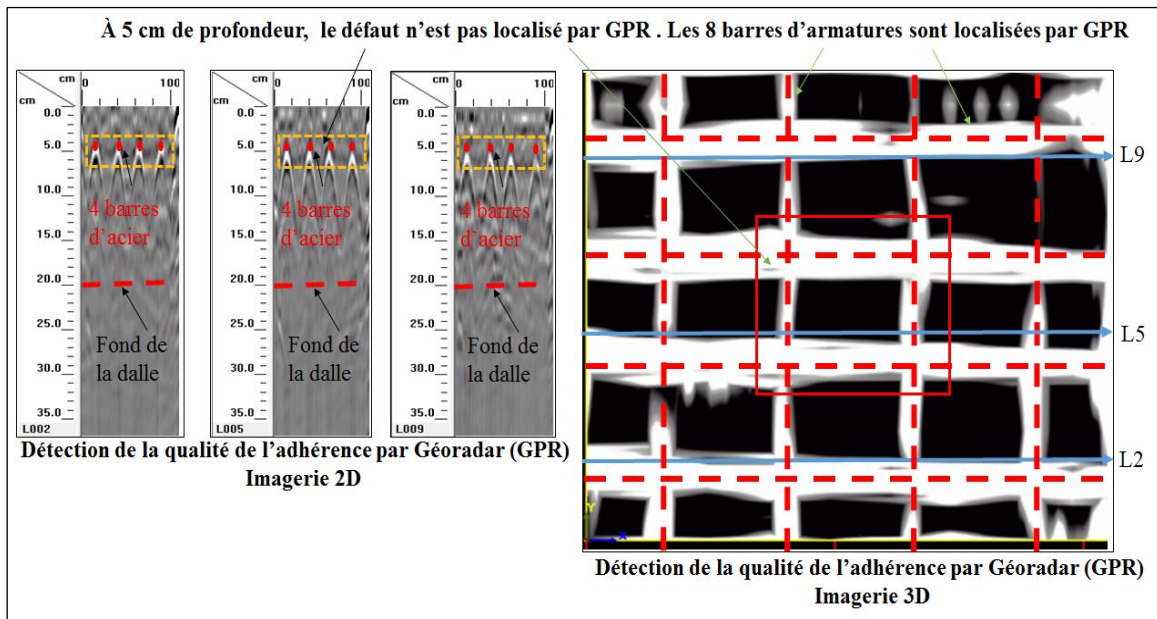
Détection de la qualité de l'adhérence par Géoradar (GPR) – Dalle avec un défaut et huit barres d'armature horizontales dans les deux directions orthogonales placées à 5 cm de profondeur - Dalle N° 8.
